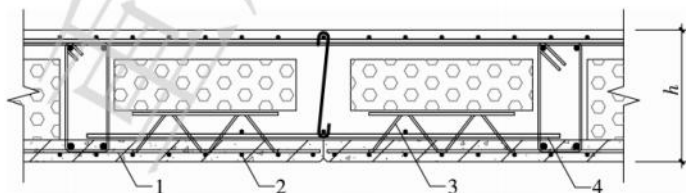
预应力预制底板空心楼盖抗劈裂钢筋示意
